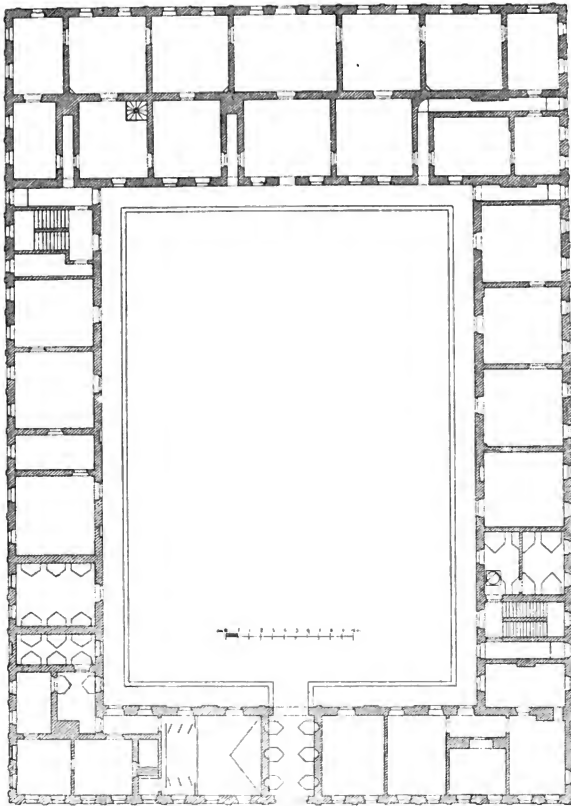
Štáhlau. Grundriss des Schlosses »Kozel.«
